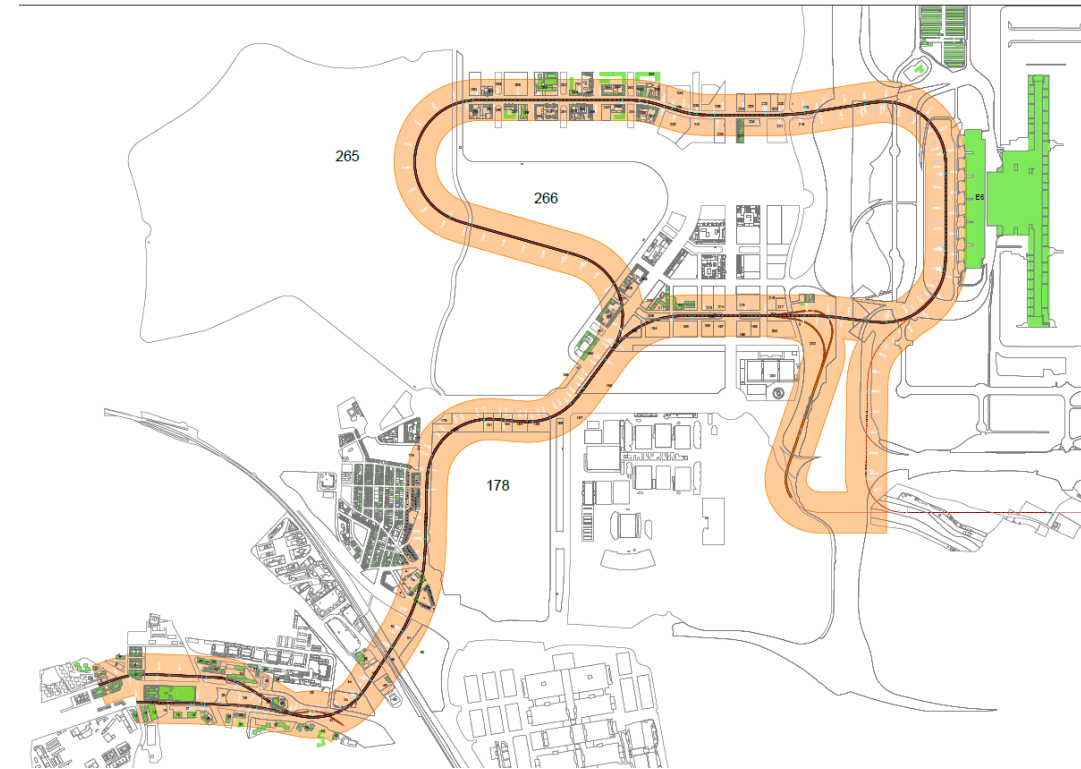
Edificios inventariados. Plano de planta de las alternativas
